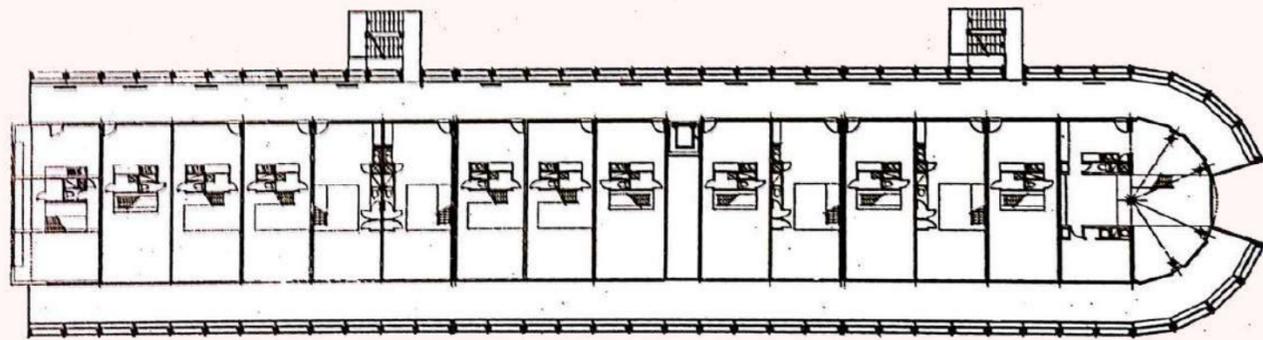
Planta baixa 1º pavimento Nemausus 1
